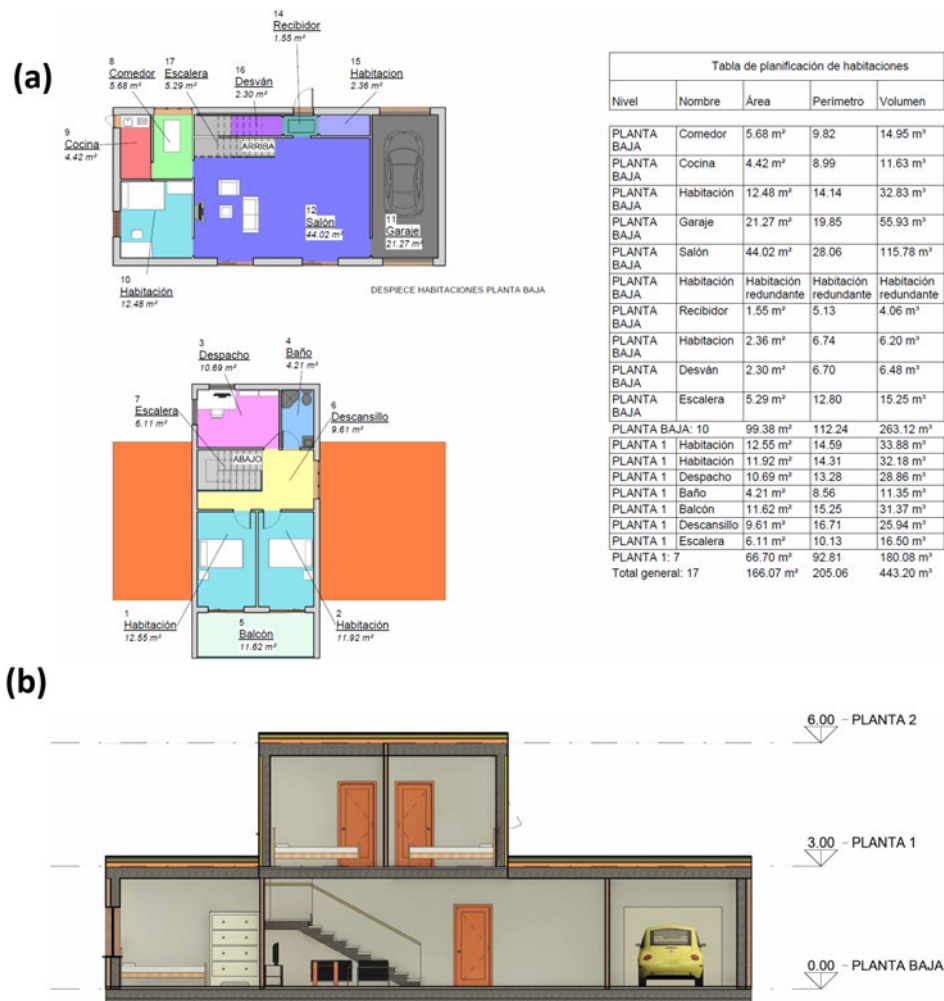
Planos arquitectónicos de REVIT: (a) Plantas y cuadro de superficies; (b) sección.
